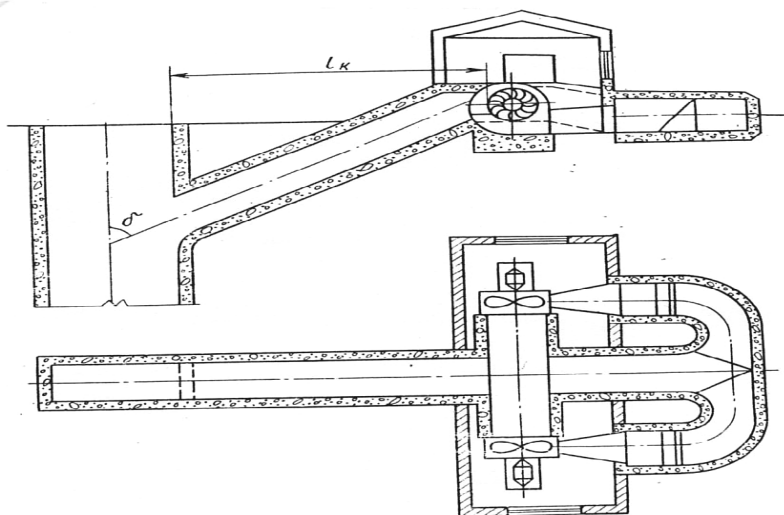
Типовая схема канала реверсивной вентиляторной установки с центробежным вентилятором, примыкающего к вертикальному или наклонному стволу (шурфу)
